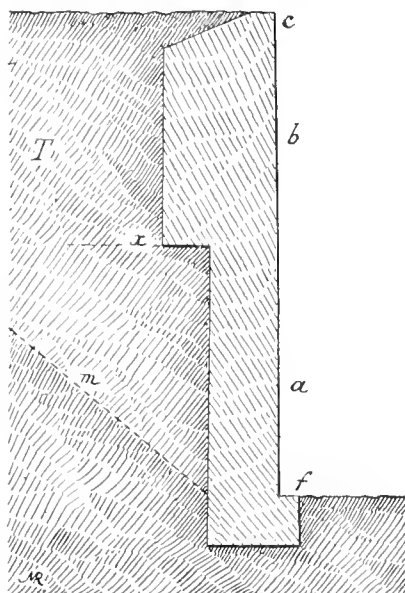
Coupe verticale d'un mur de soutènement du système Rabut.
